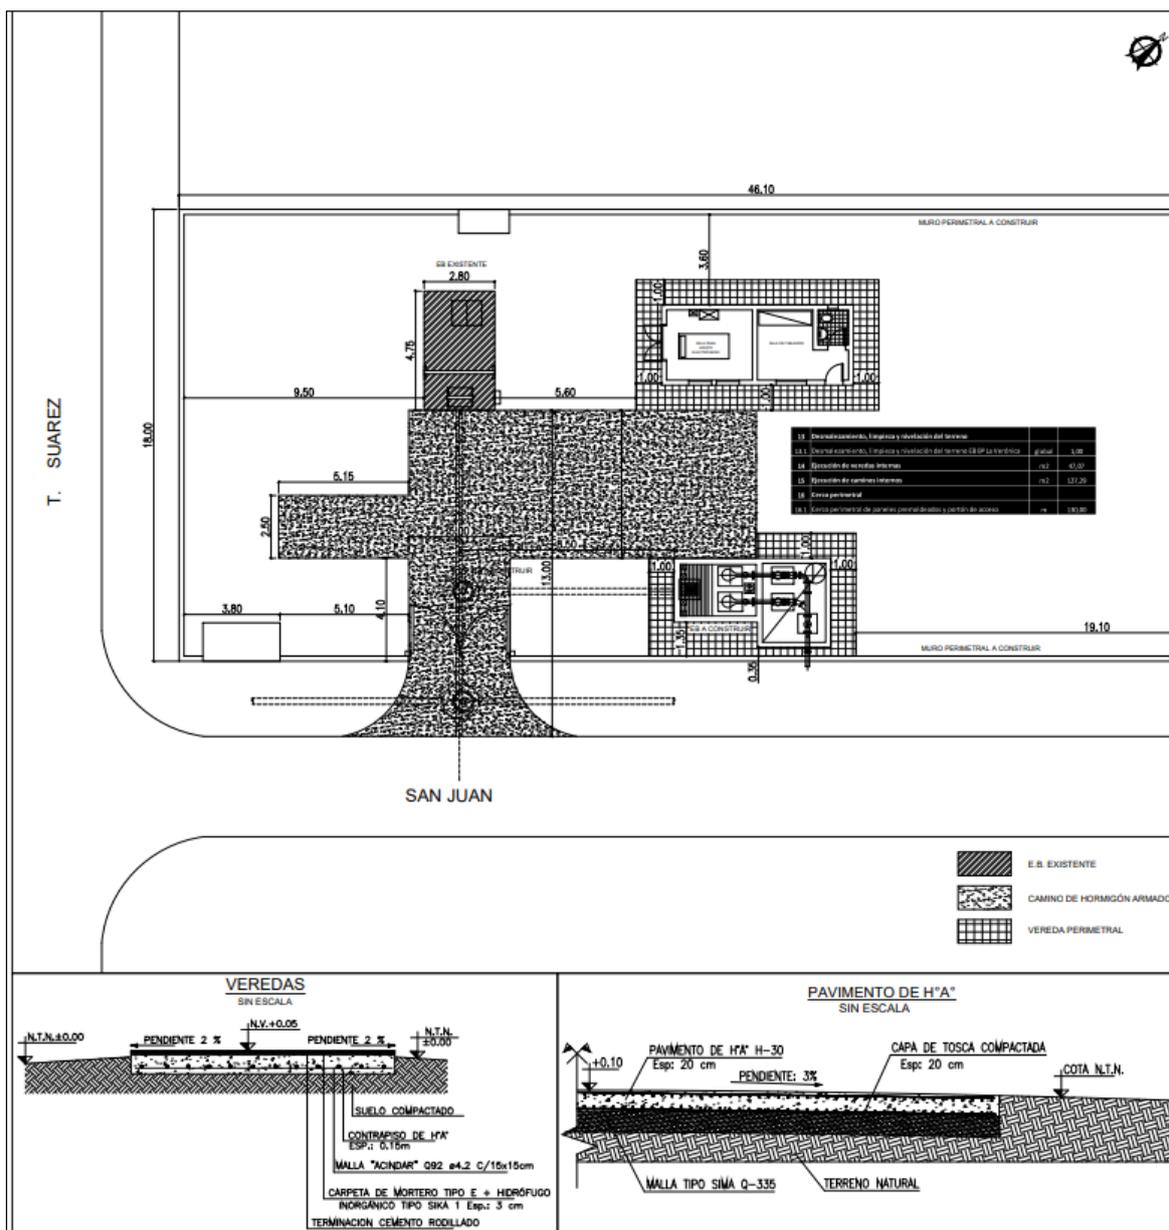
Plano de pavimento y veredas internas a ejecutar en Estación de bombeo, barrio La Verónica (EEB 1).
